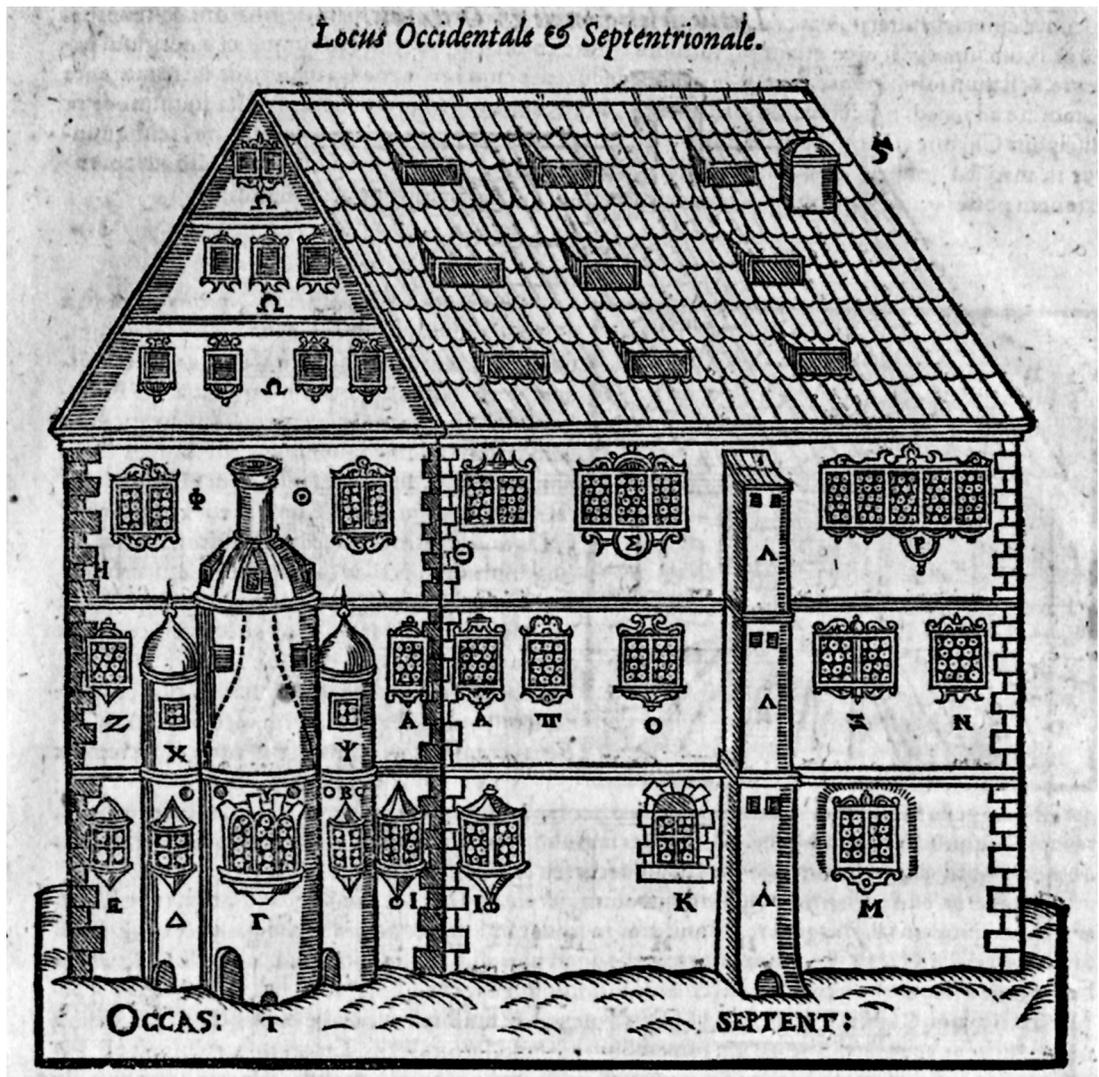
Aufriss des Gebäudes von der Nord- und Westseite mit dem Erker, den das halbrunde Laboratorium im Erdgeschoss und ersten Obergeschoss bildet, in: Andreas Libavius, *Alchymia* [...], Frankfurt a. M. 1606, Anh. Buch 1, S. 98 (Ausst.kat. Goldenes Wissen 2014, Abb. 52)
